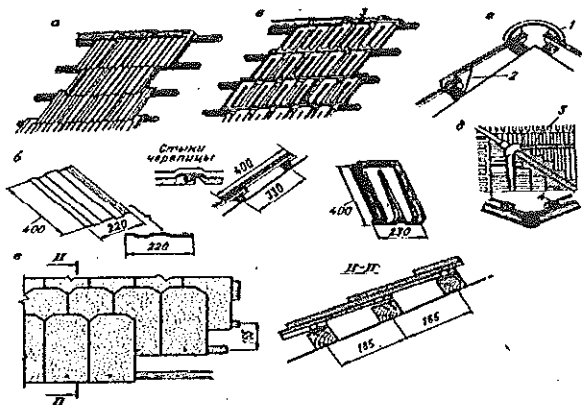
Виды и способы устройства и крепления черепичной керамической кровли
